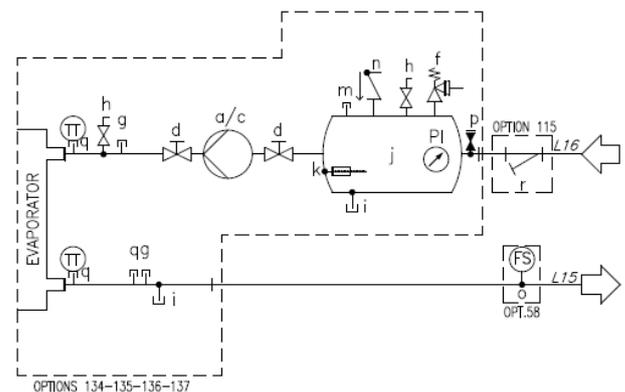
Hydraulikschema (opt. 78-79-80-81/134-135-136-137)
